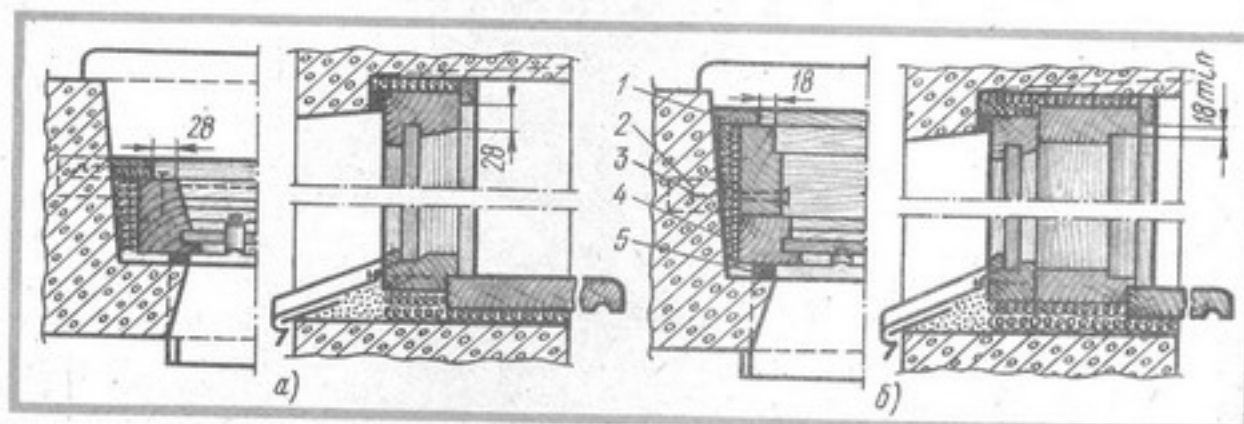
Установка оконных блоков в проемы каменных стен жилых и общественных зданий:
